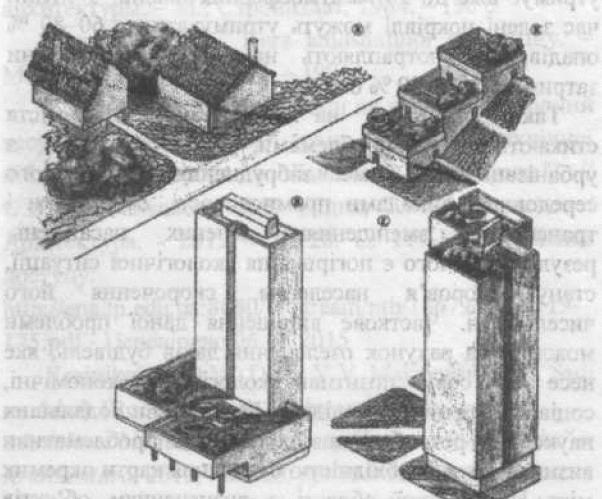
Типологія садів на дахах / Types of gardens on roofs
